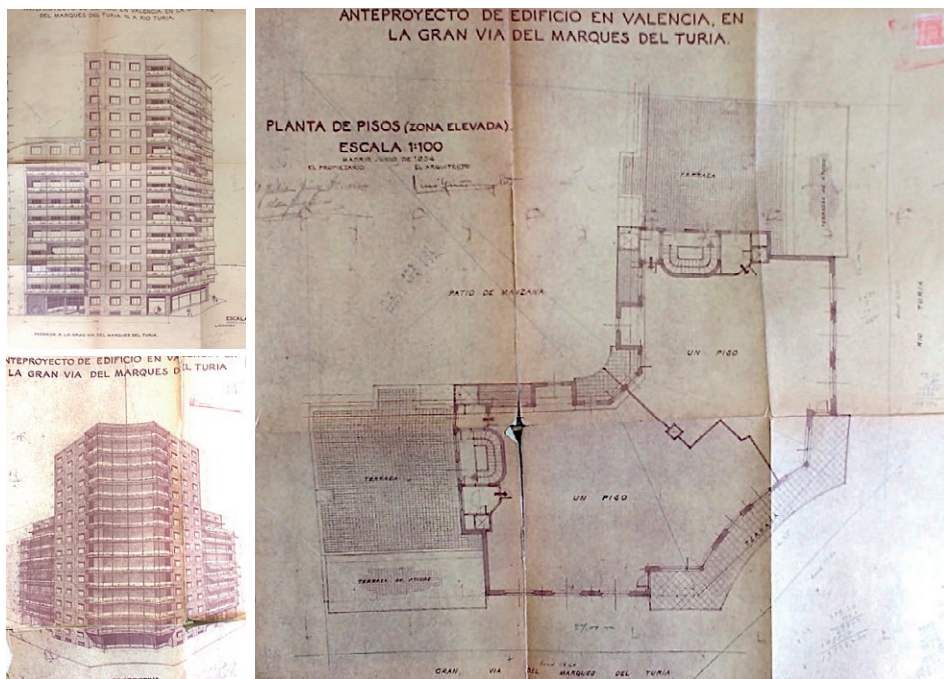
Fachadas y planta general del anteproyecto de 1954.
